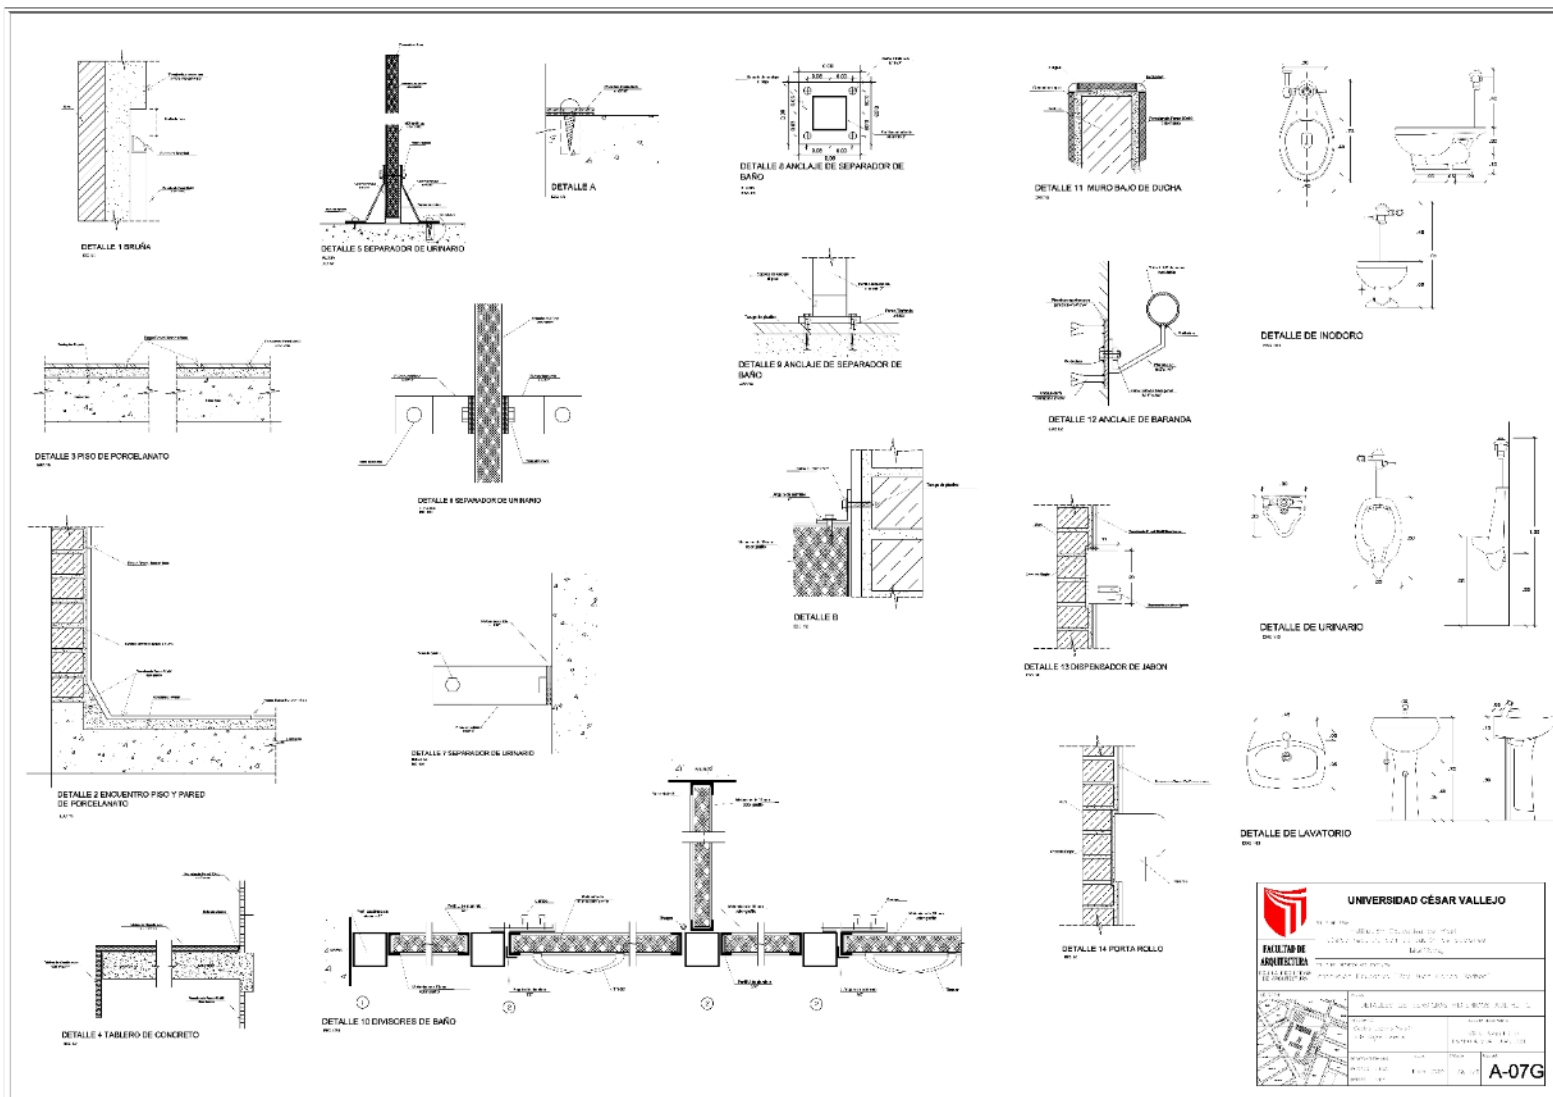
Plano Detalles de servicios higiénicos bloque “G”, Fuente: elaboración propia
